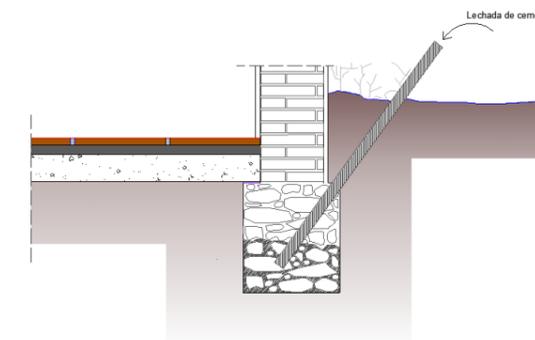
Detalle inyección de lechada de cemento en cimentación. Fuente: autor propio
